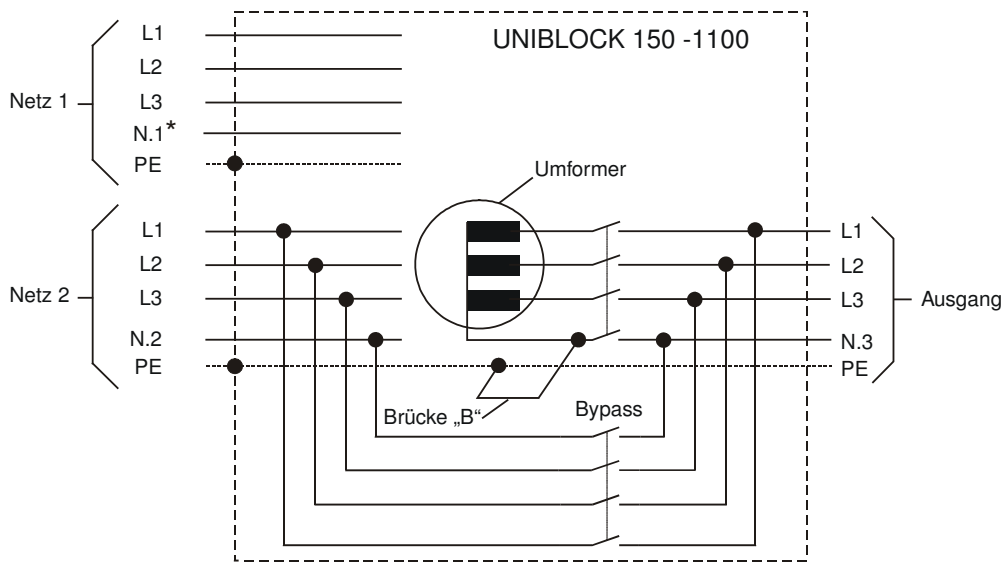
Anschlussschema UB220 – UB625 für Anschluss an TN-S-Netz
